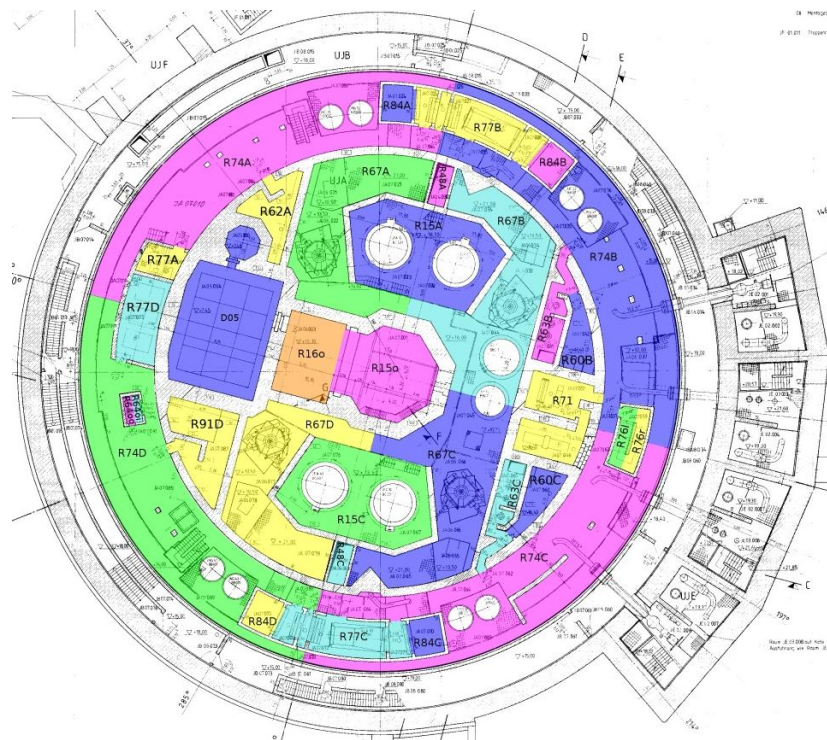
Schnitt durch den SHB bei +16,4 m (Höhenkote +20 m)
